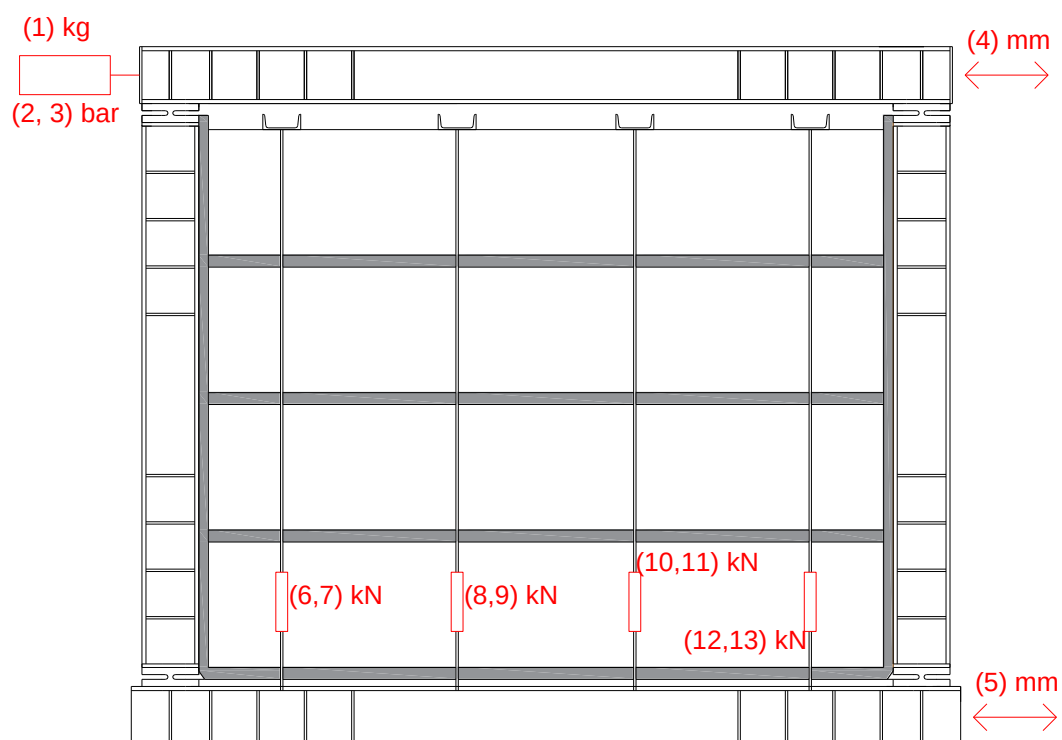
Posizionamento strumentazione da 1 a 9
